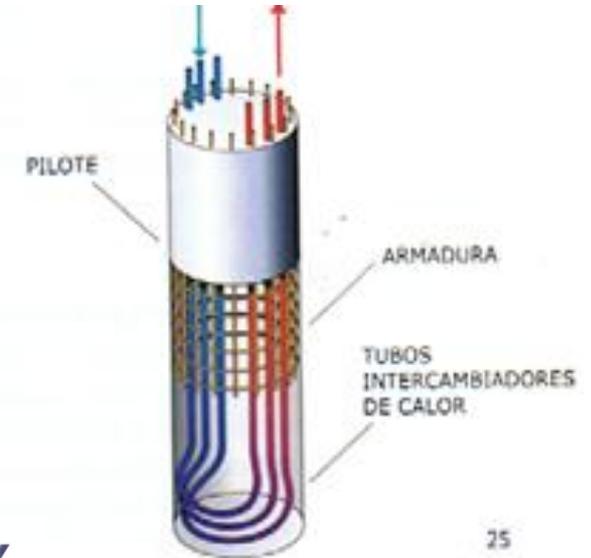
Vista en sección transversal de la colocación de las tuberías dentro de la armadura del pilote (Fuente: www.enercnet.com).
